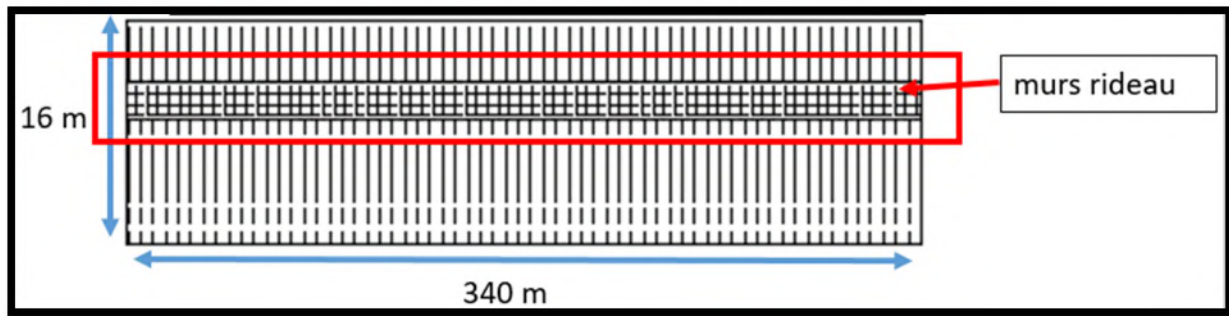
Façade Auto de hangar industrielle, autocad , source auteur
